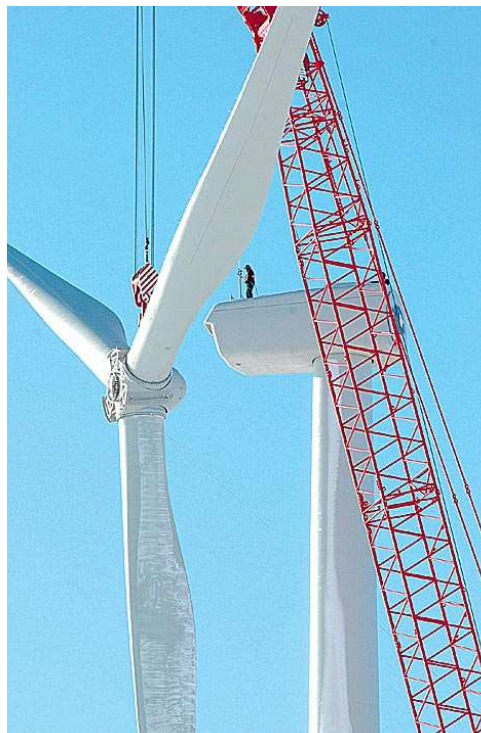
Installazione della turbina: montaggio del rotore.
